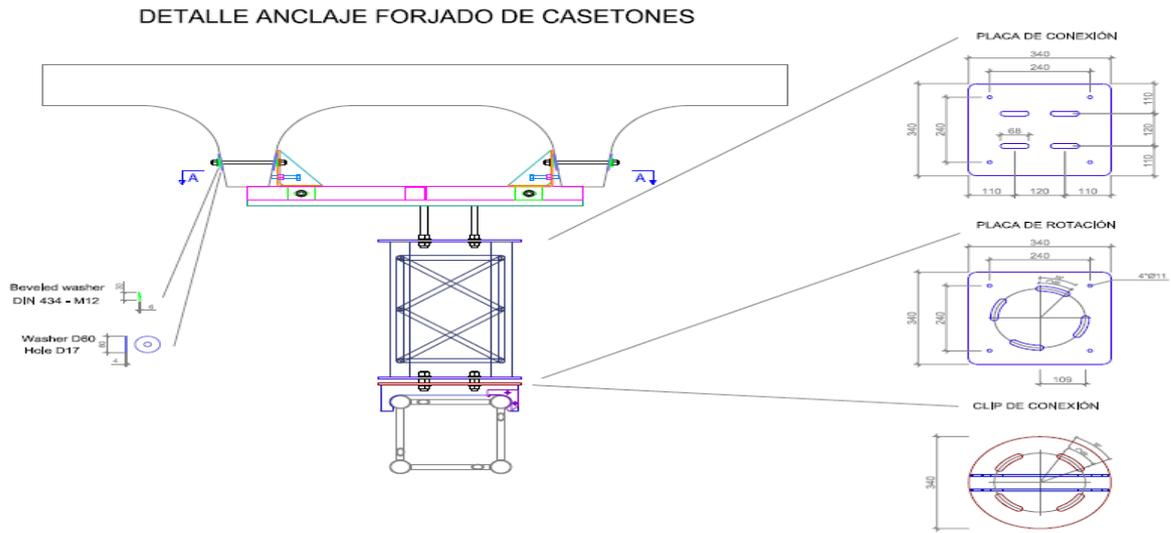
Ejemplo de detalles de anclaje Truss (fuente: propia)
